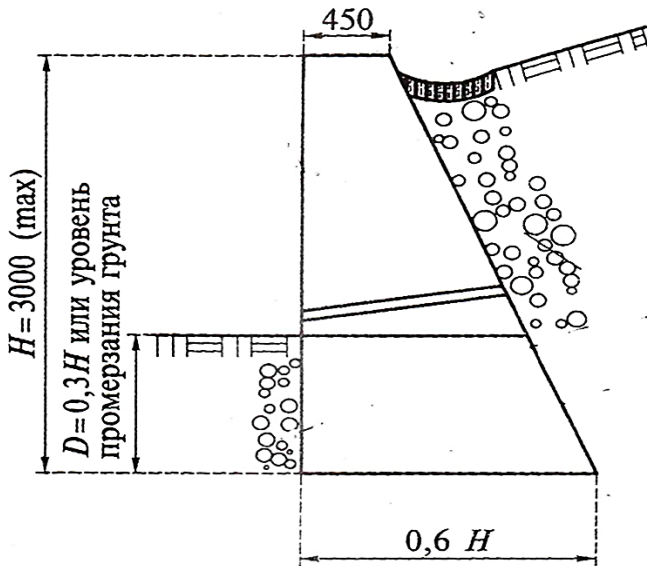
Глубина заложения фундамента бетонной стенки
